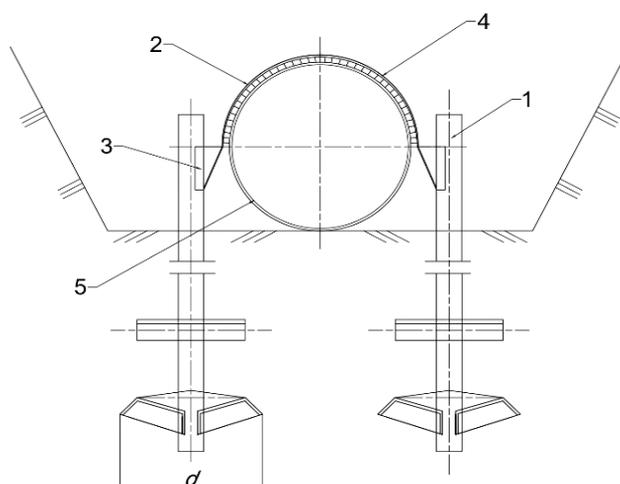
Анкерное устройство раскрывающегося типа: 1 – анкер раскрывающийся; 2 – прокладка; 3 – хомут; 4 – мат; 5 – трубопровод [1]
